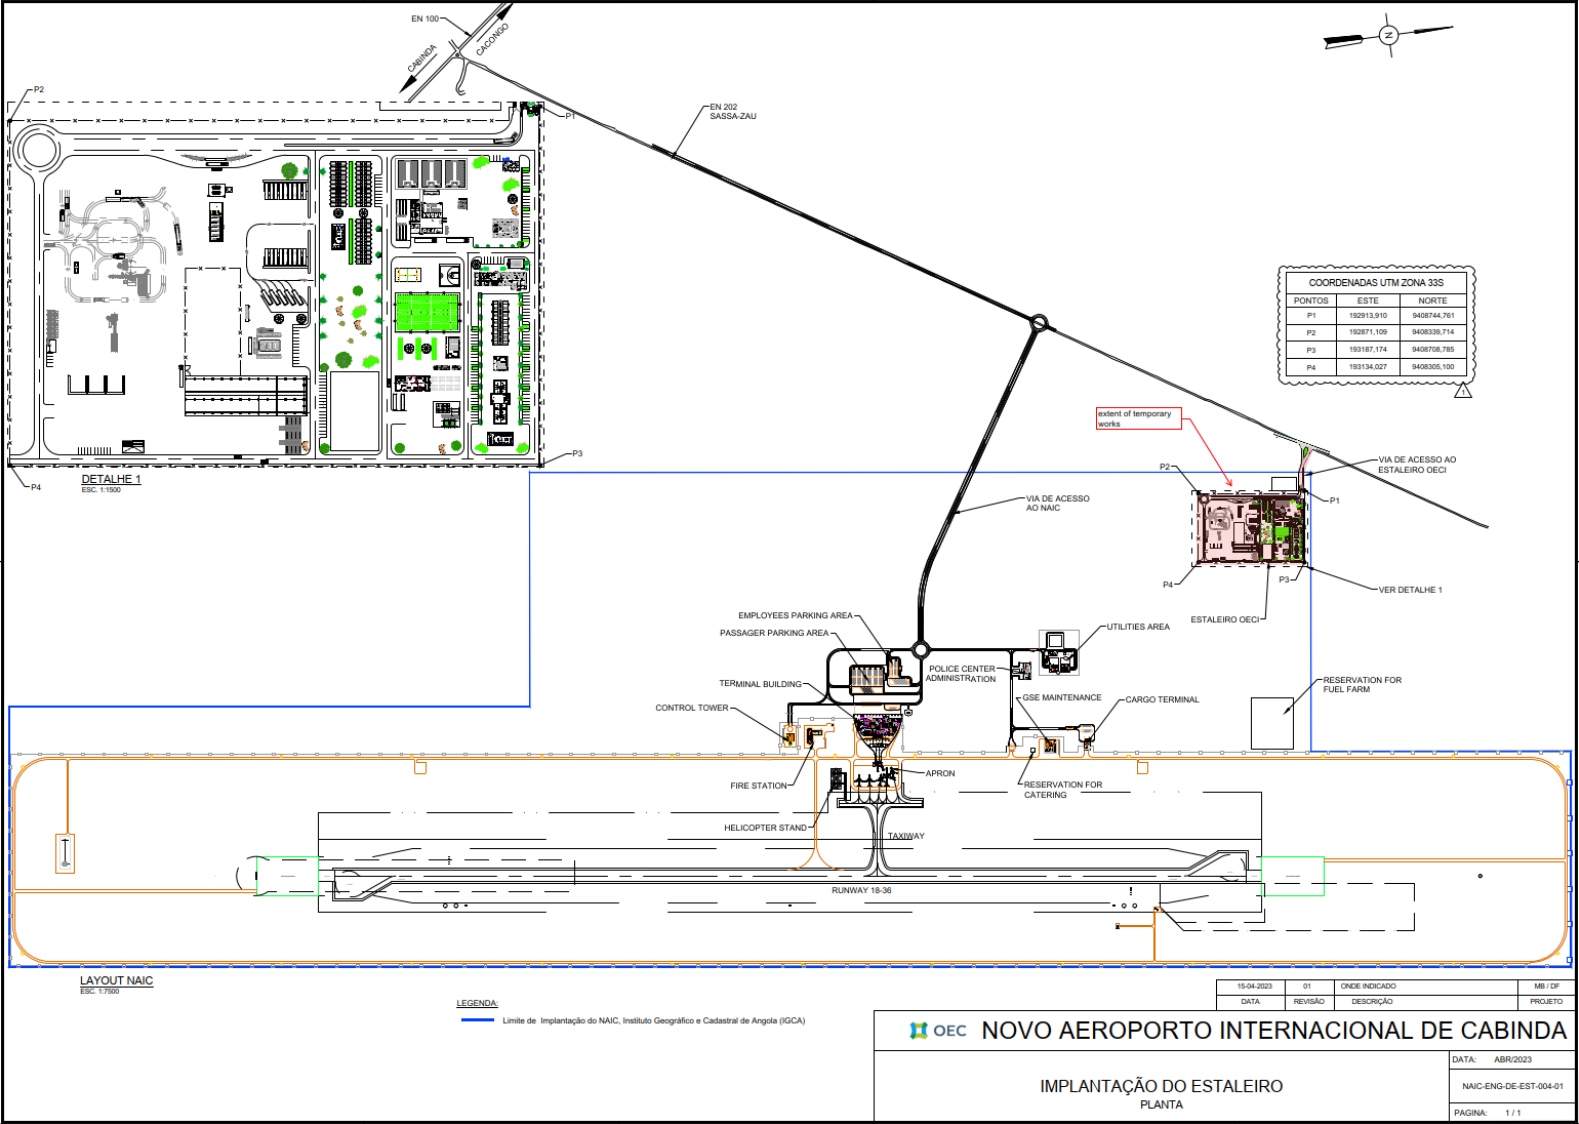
Localização do acampamento de construção dentro da área do NAIC.
